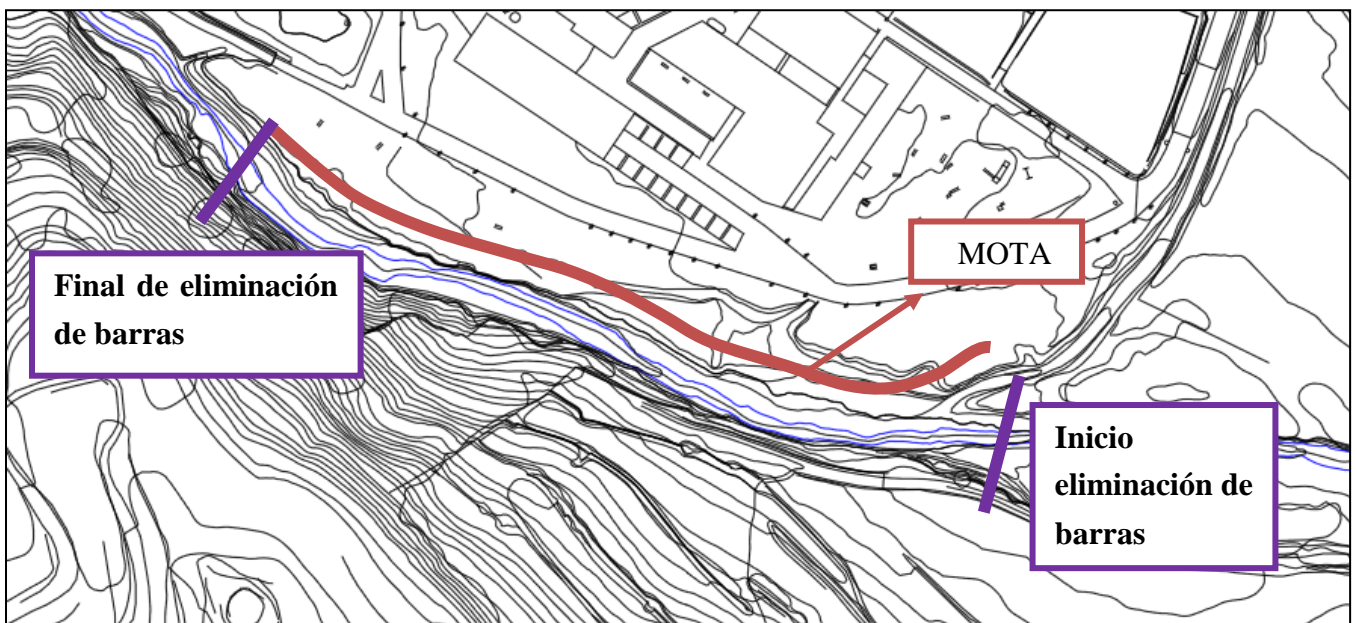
Esquema en planta de las actuaciones para la alternativa 1
